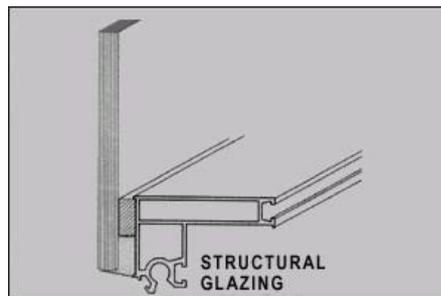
Perfil quadro fachada Stick *Glazing* (colado)
